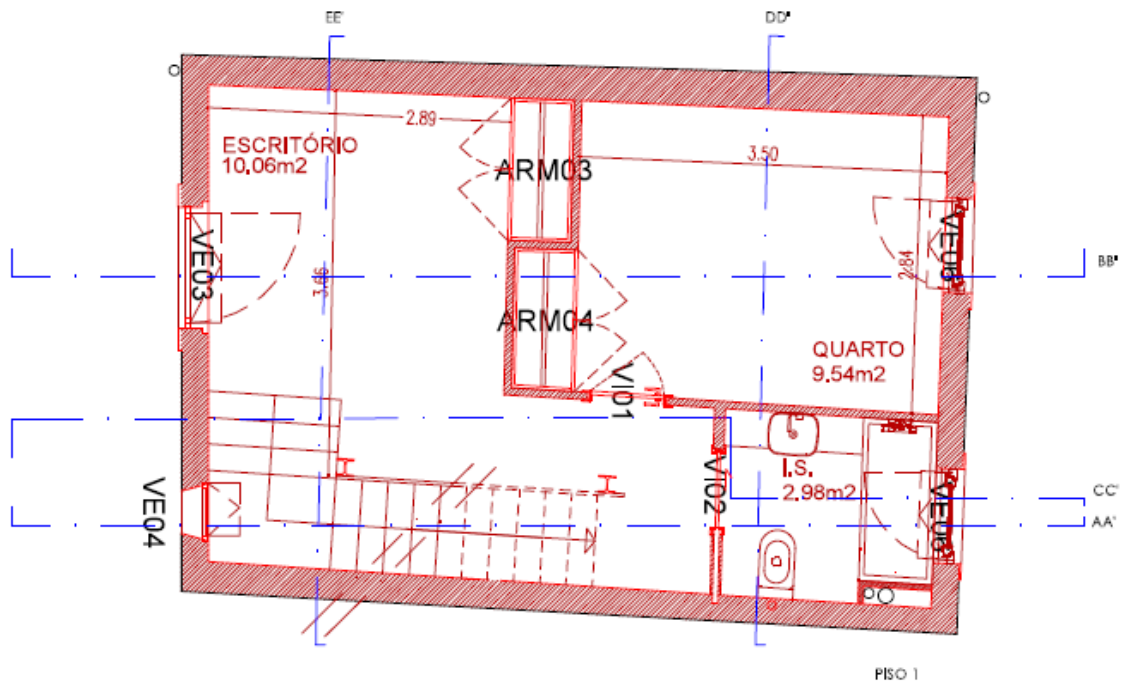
projeto de arquitetura piso 1 (Seleiro, Cruz, & Sandra, proposto planta dos pisos, 2017)
